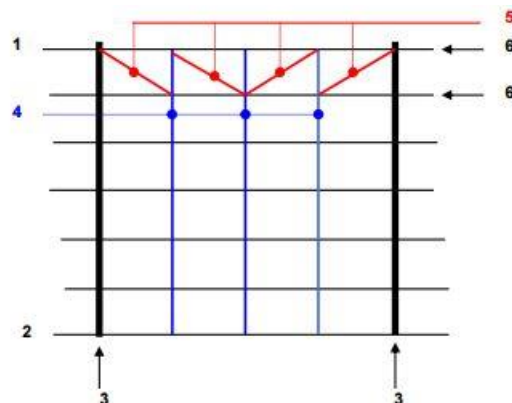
Tirantes, corte da fachada lateral [21]
